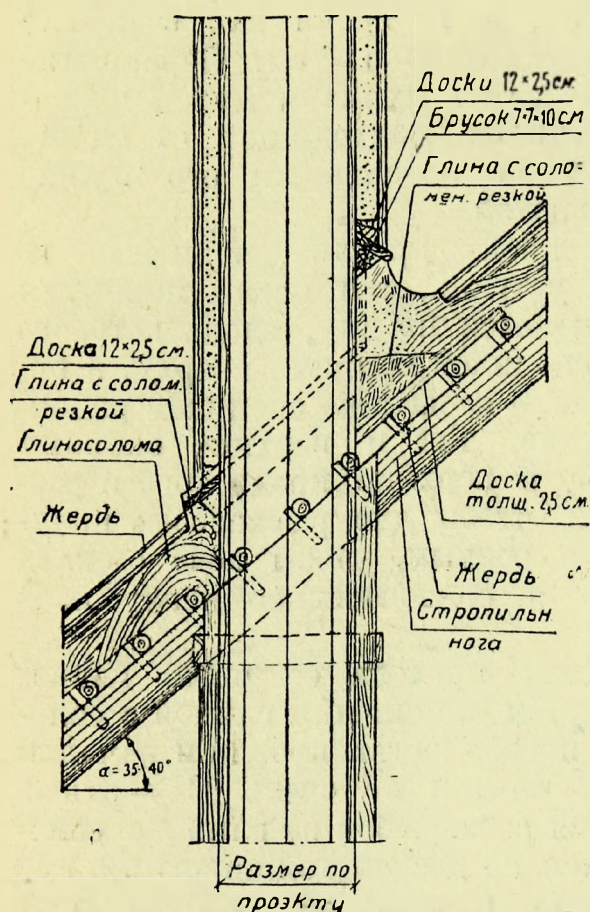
Деталь обделки вентиляционных труб в глиносоломенной кровле.
